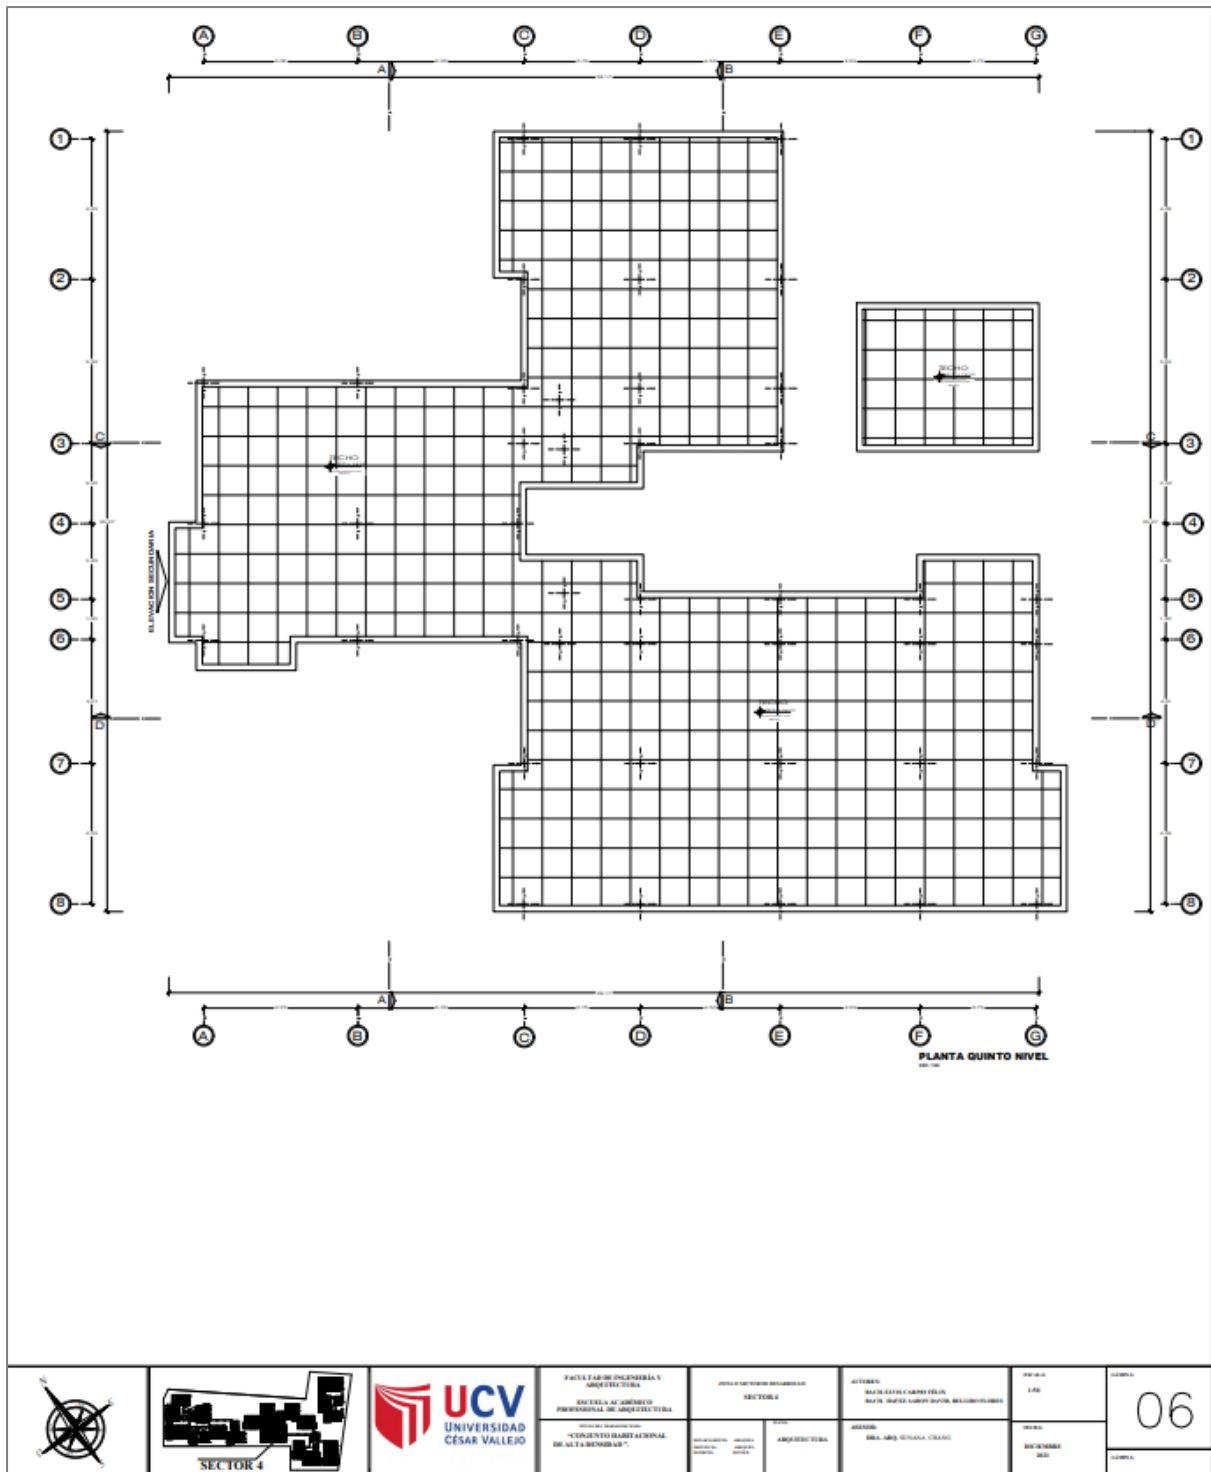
Planos de Arquitectura – 06 - Bloque 4 – Planta de Techos
